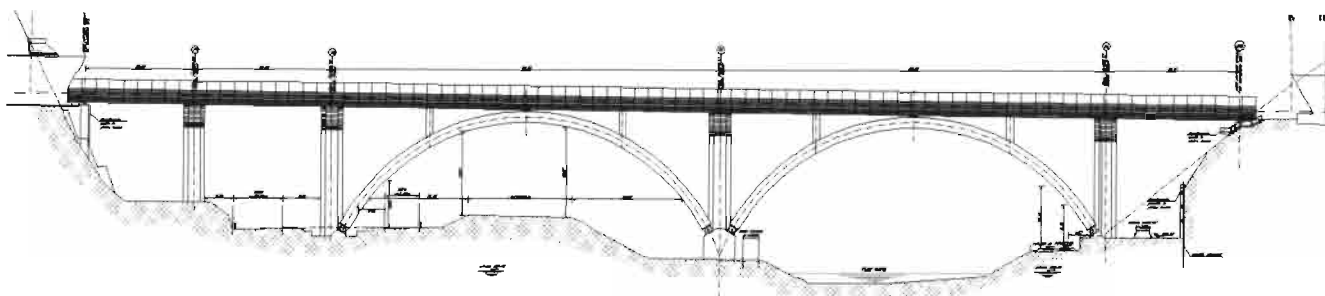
Ponte Fiume Isarco: Prospetto Viadotto Binario Dispari
